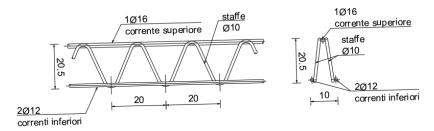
Sezione tipologica traliccio tipo Pittini
